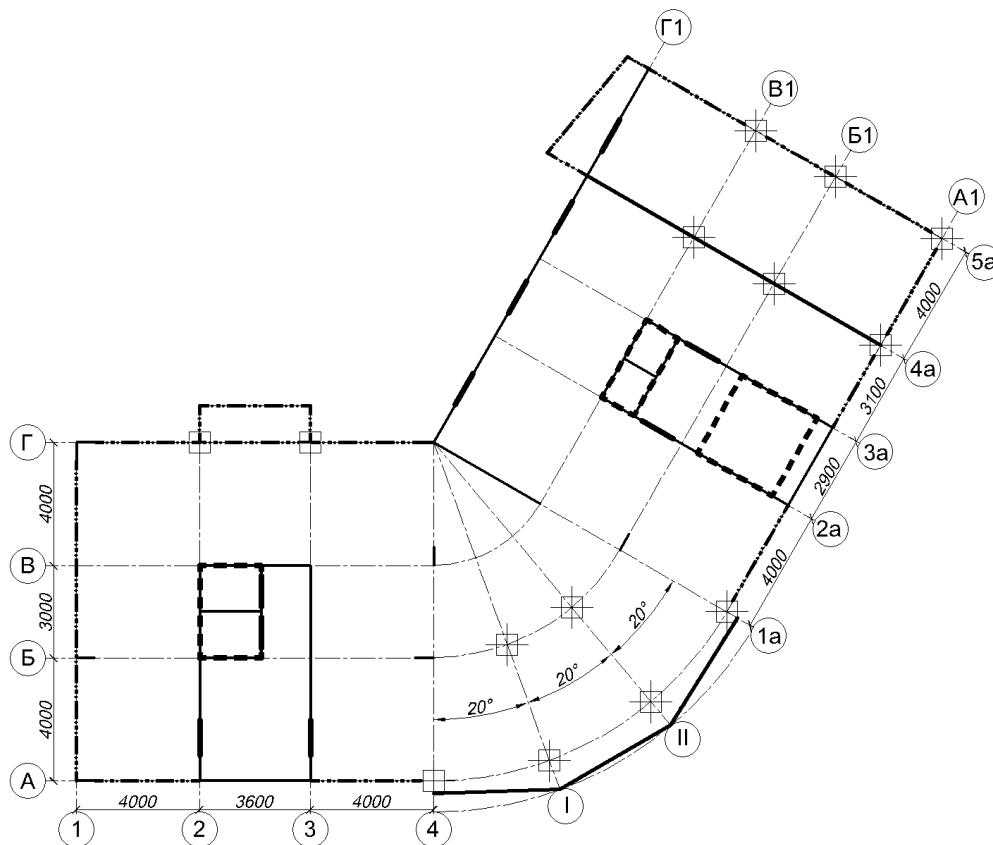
Плита перекрытия типового этажа с заданными нагрузками
